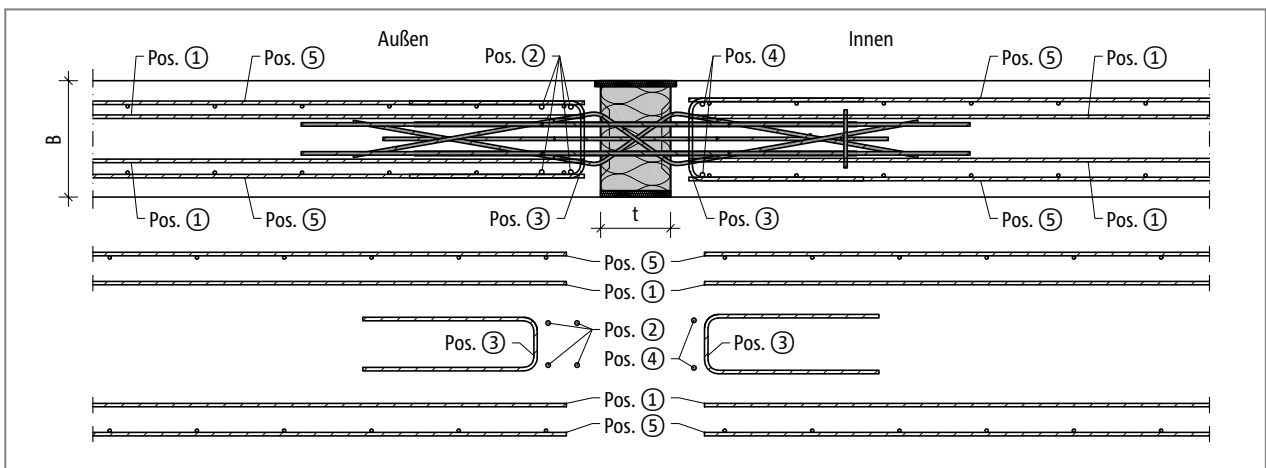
Schöck Isokorb® XT Typ W: Bauseitige Bewehrung; Grundriss
